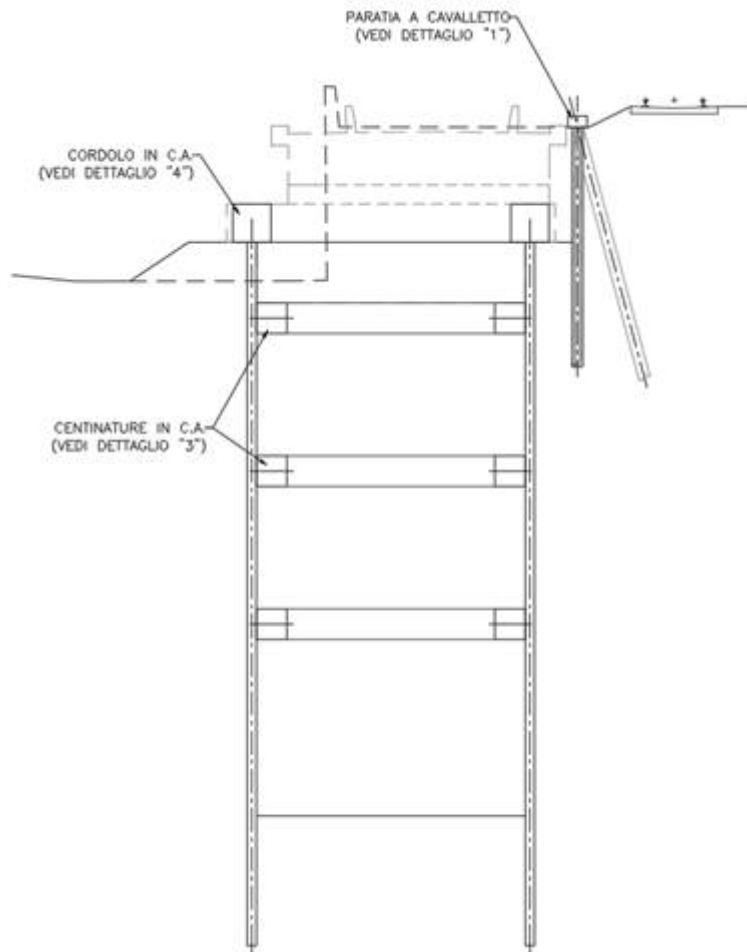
Sezione Opere Provvisionali Spalla B
